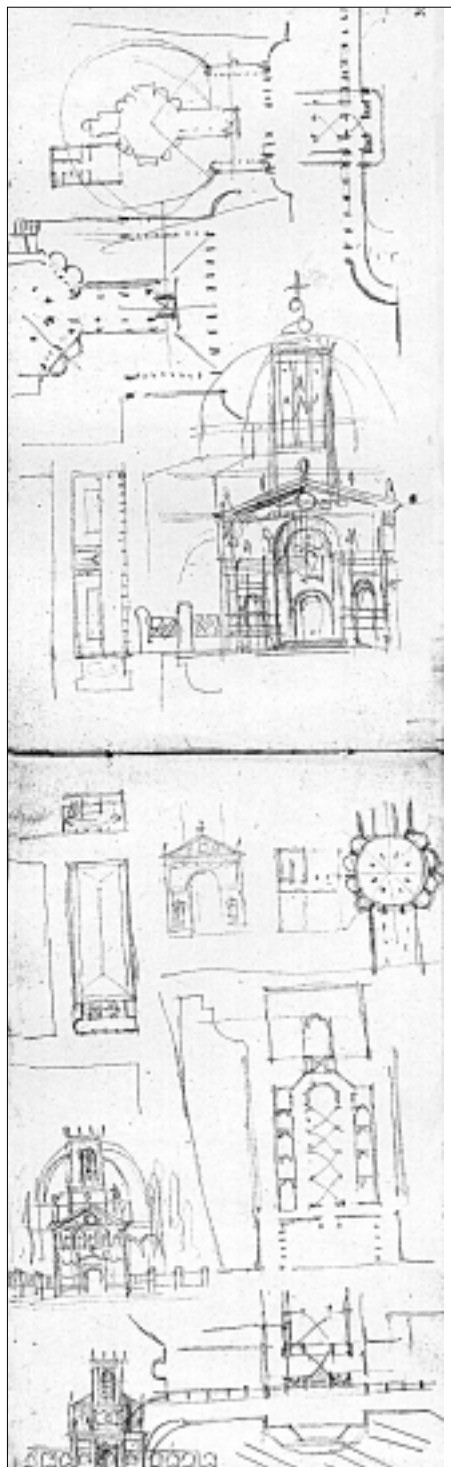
HENRI LABROUSTE. CROQUIS POUR L'ÉGLISE SAINT-AUBIN. Académie d'Architecture, fonds Labrouste n° 355, f° 31 v° et 32. Plans longitudinaux et plans centrés se côtoient. La façade est d'abord pensée comme un arc de triomphe.
